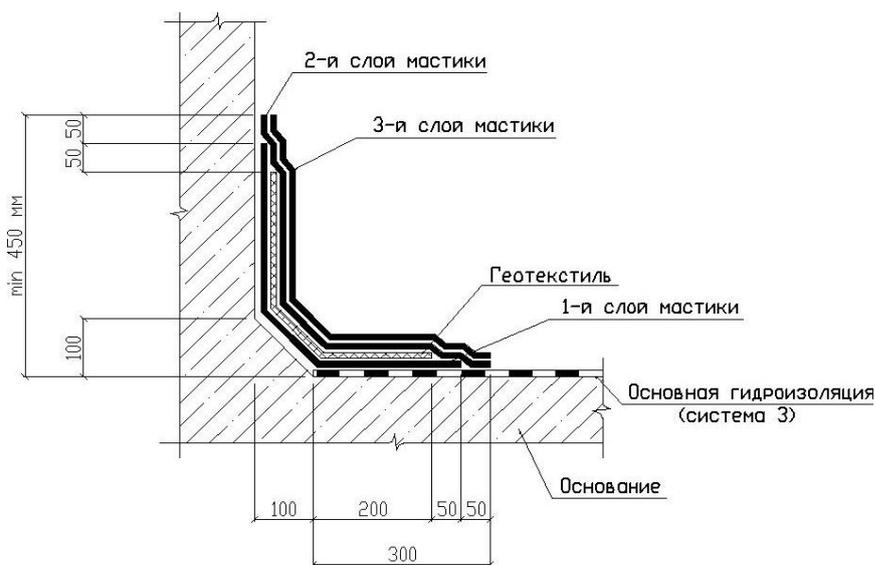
а. Устройство гидроизоляции примыкания после нанесения основного кровельного покрытия с одним слоем геотекстиля.
